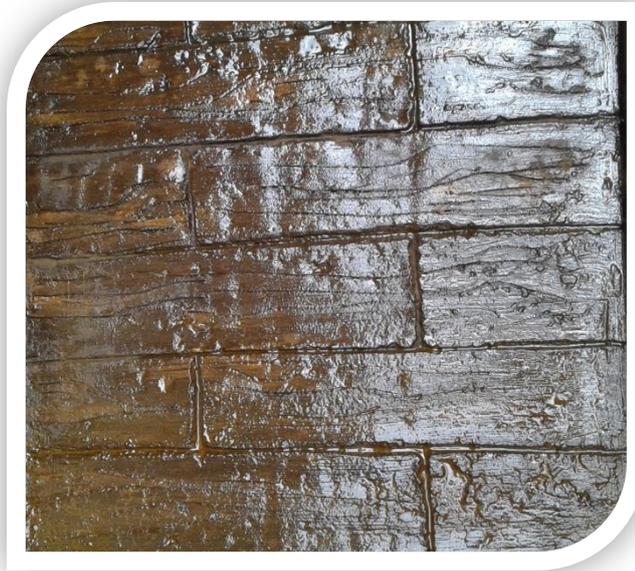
Piso Decorativo con Argamasa del Terreno y Cemento, Acabado Tipo Ladrillo.
